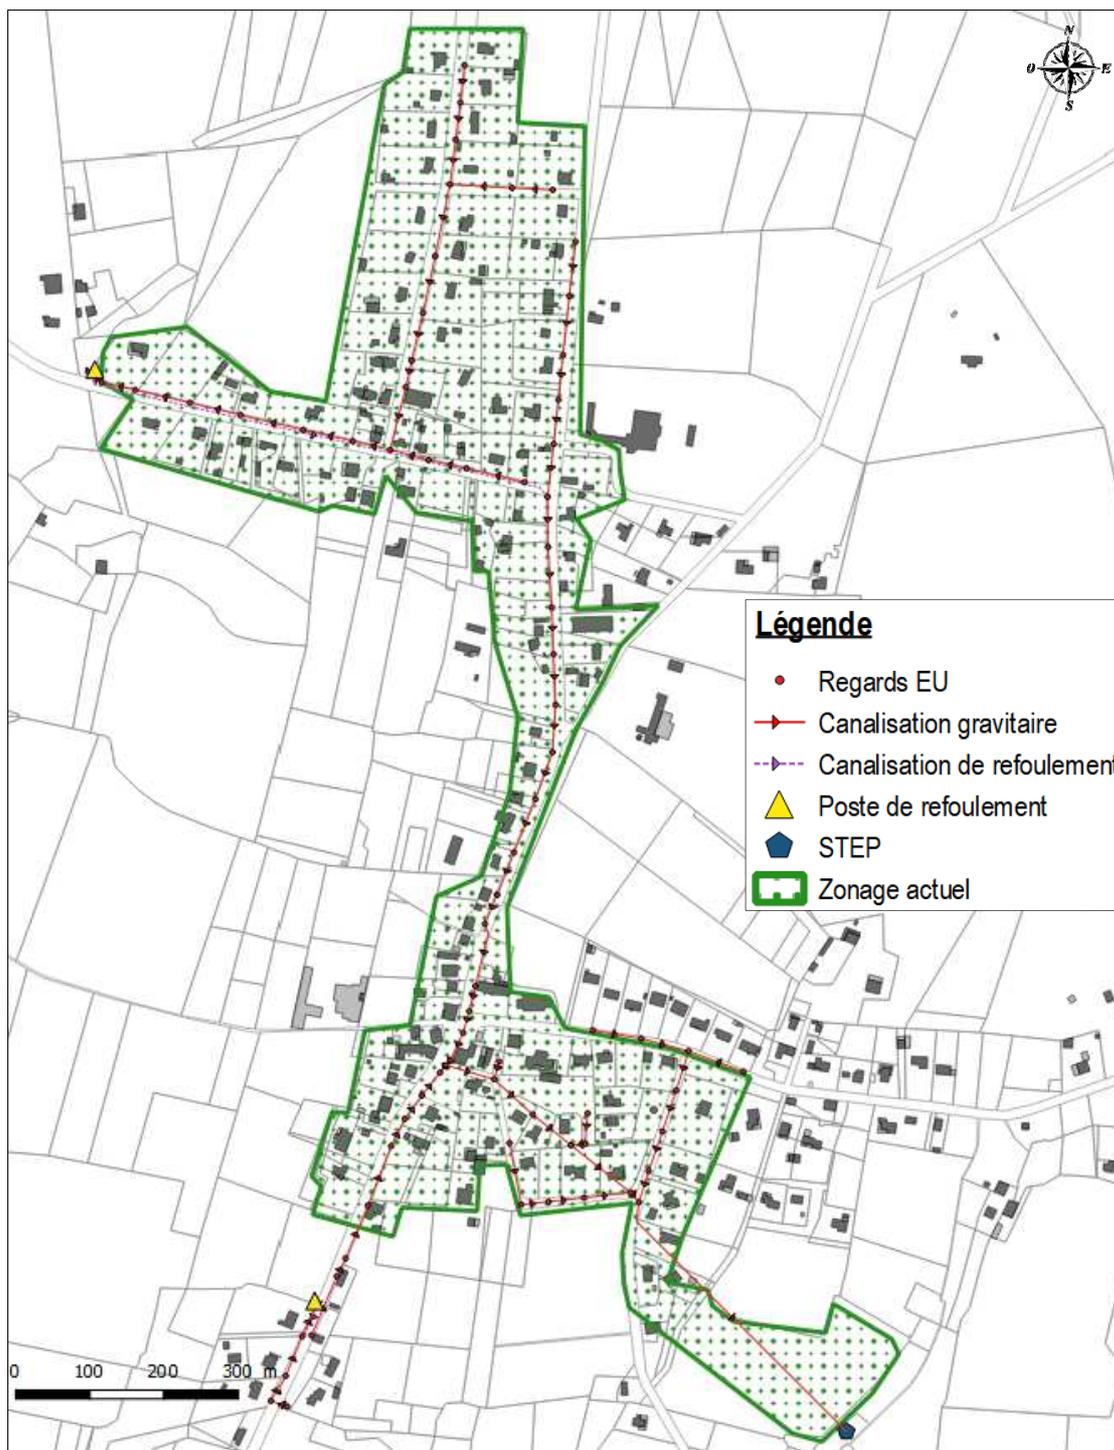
Plan de zonage d'assainissement en vigueur et plans des réseaux d'eaux usées existants
